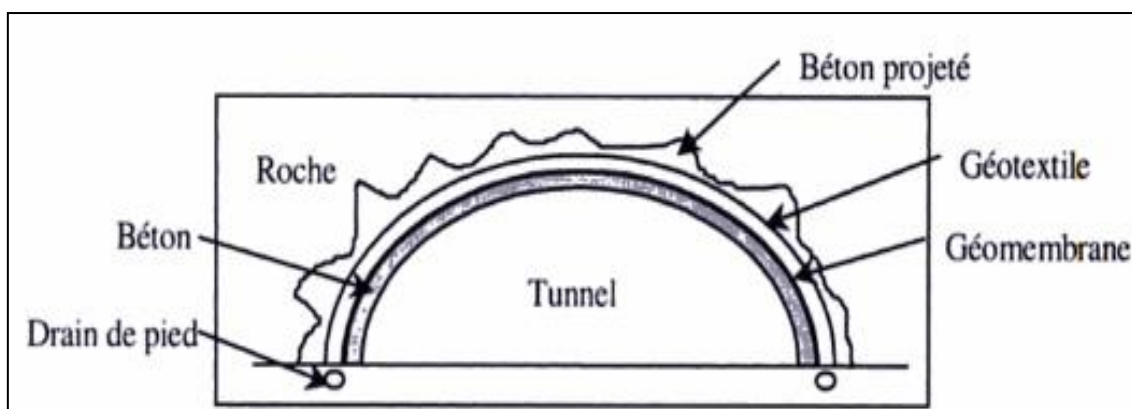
Étanchéité d'un tunnel par la géomembrane. (Rollin et al., 2002)
